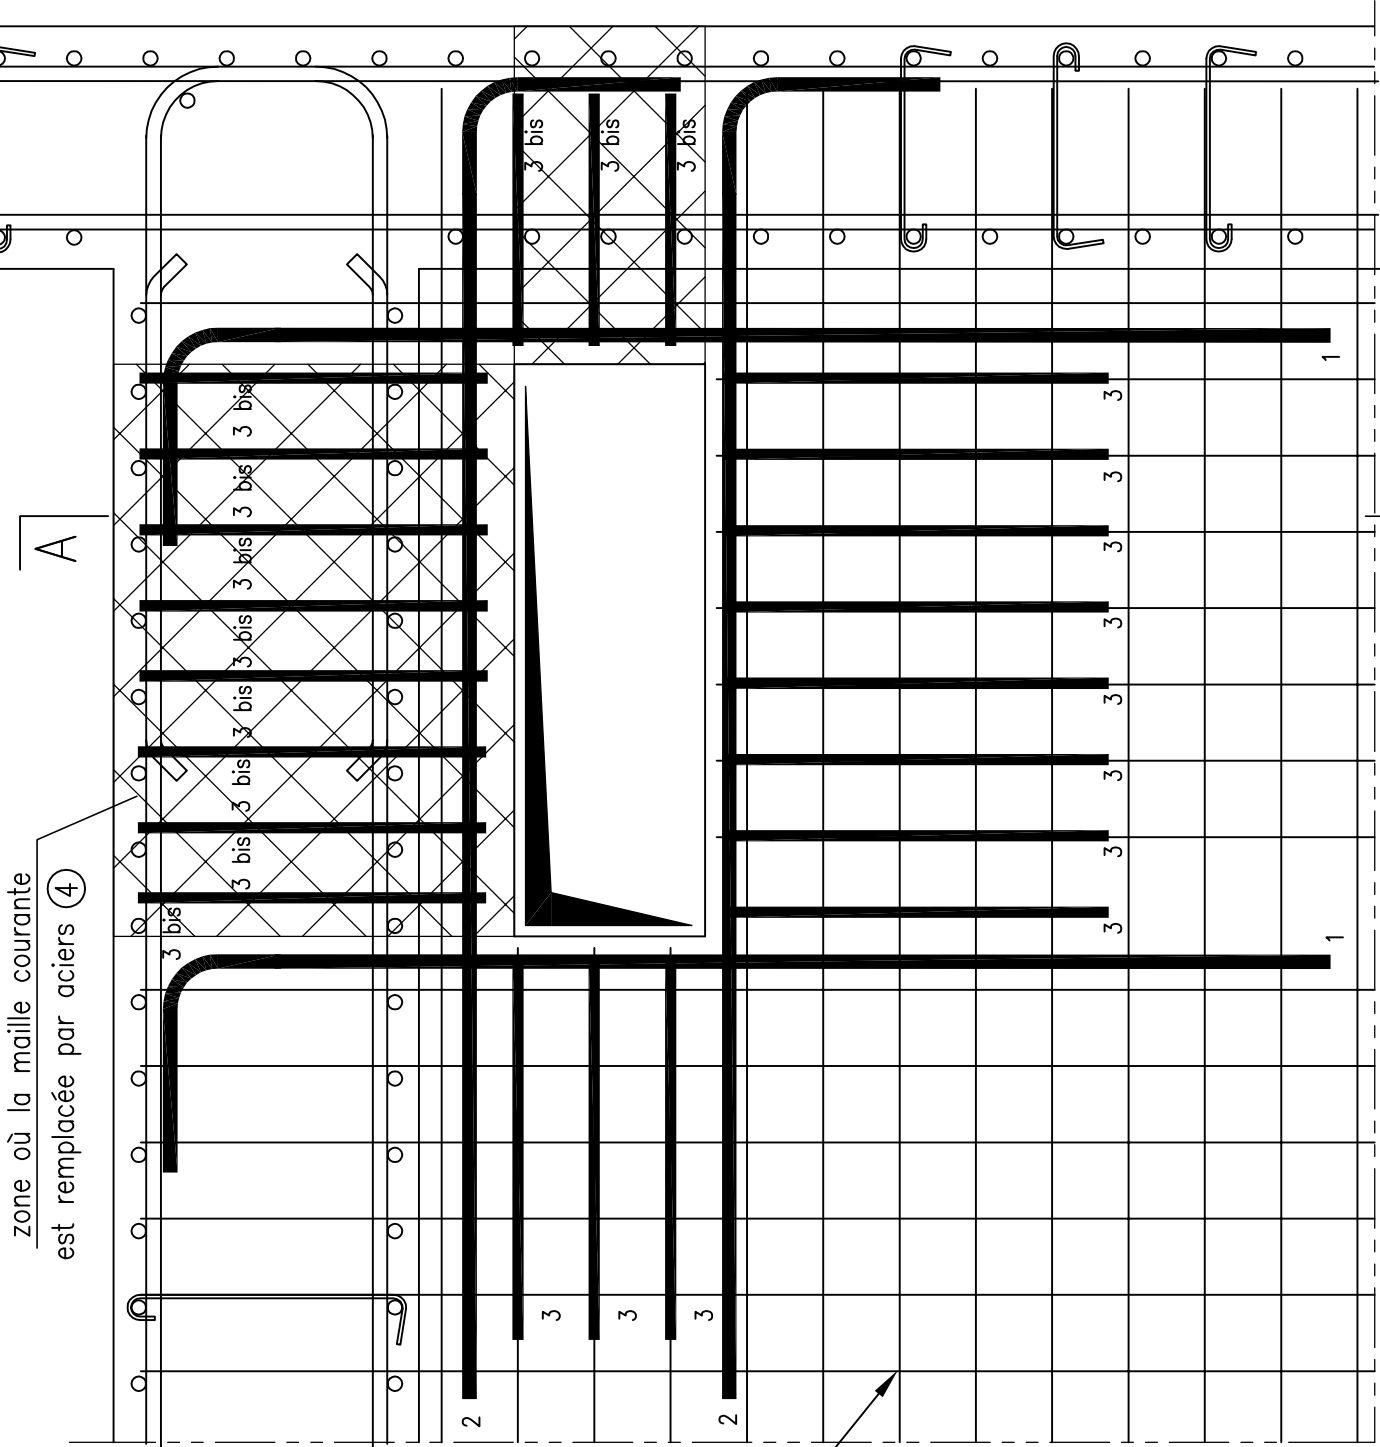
DETAIL D'UNE TREMIE SIMPLE TRES PROCHE D'UN VOILE OU D'UN PLANCHER
